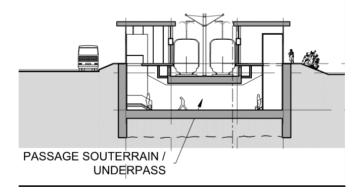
Croquis – coupe transversale - station projetée au niveau du sol
